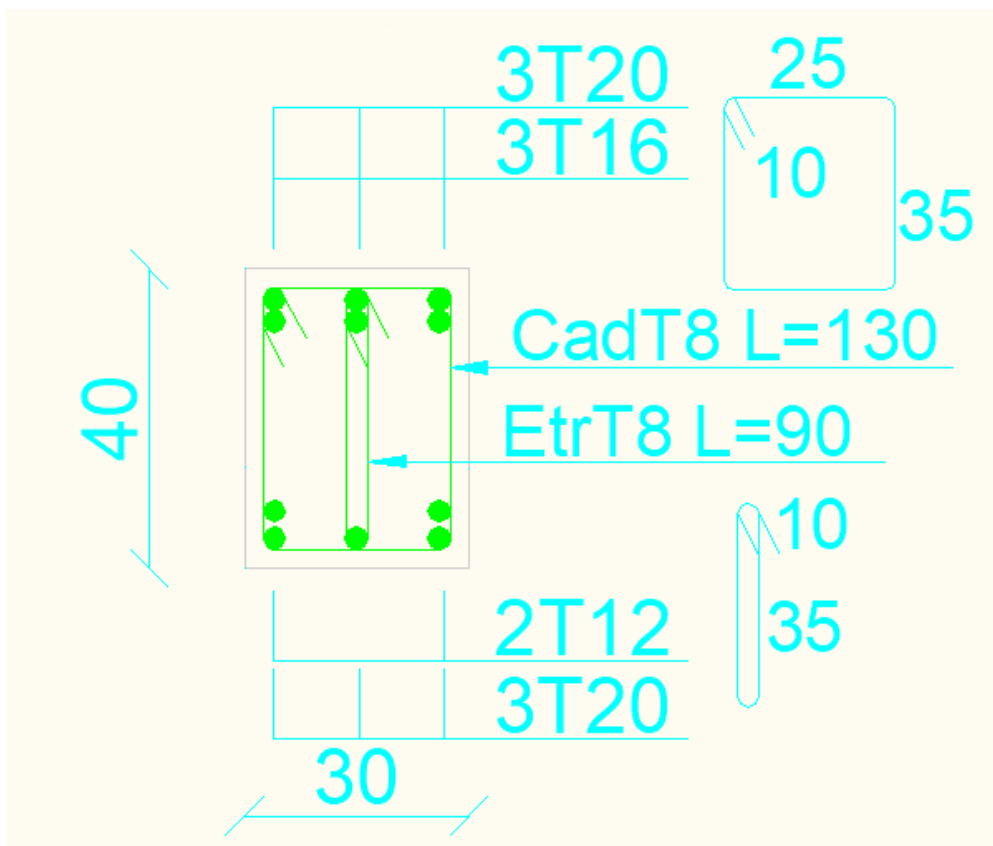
Schéma de ferrailage poutre secondaire reposant sur voile Niv 7 en appuis et travée.
